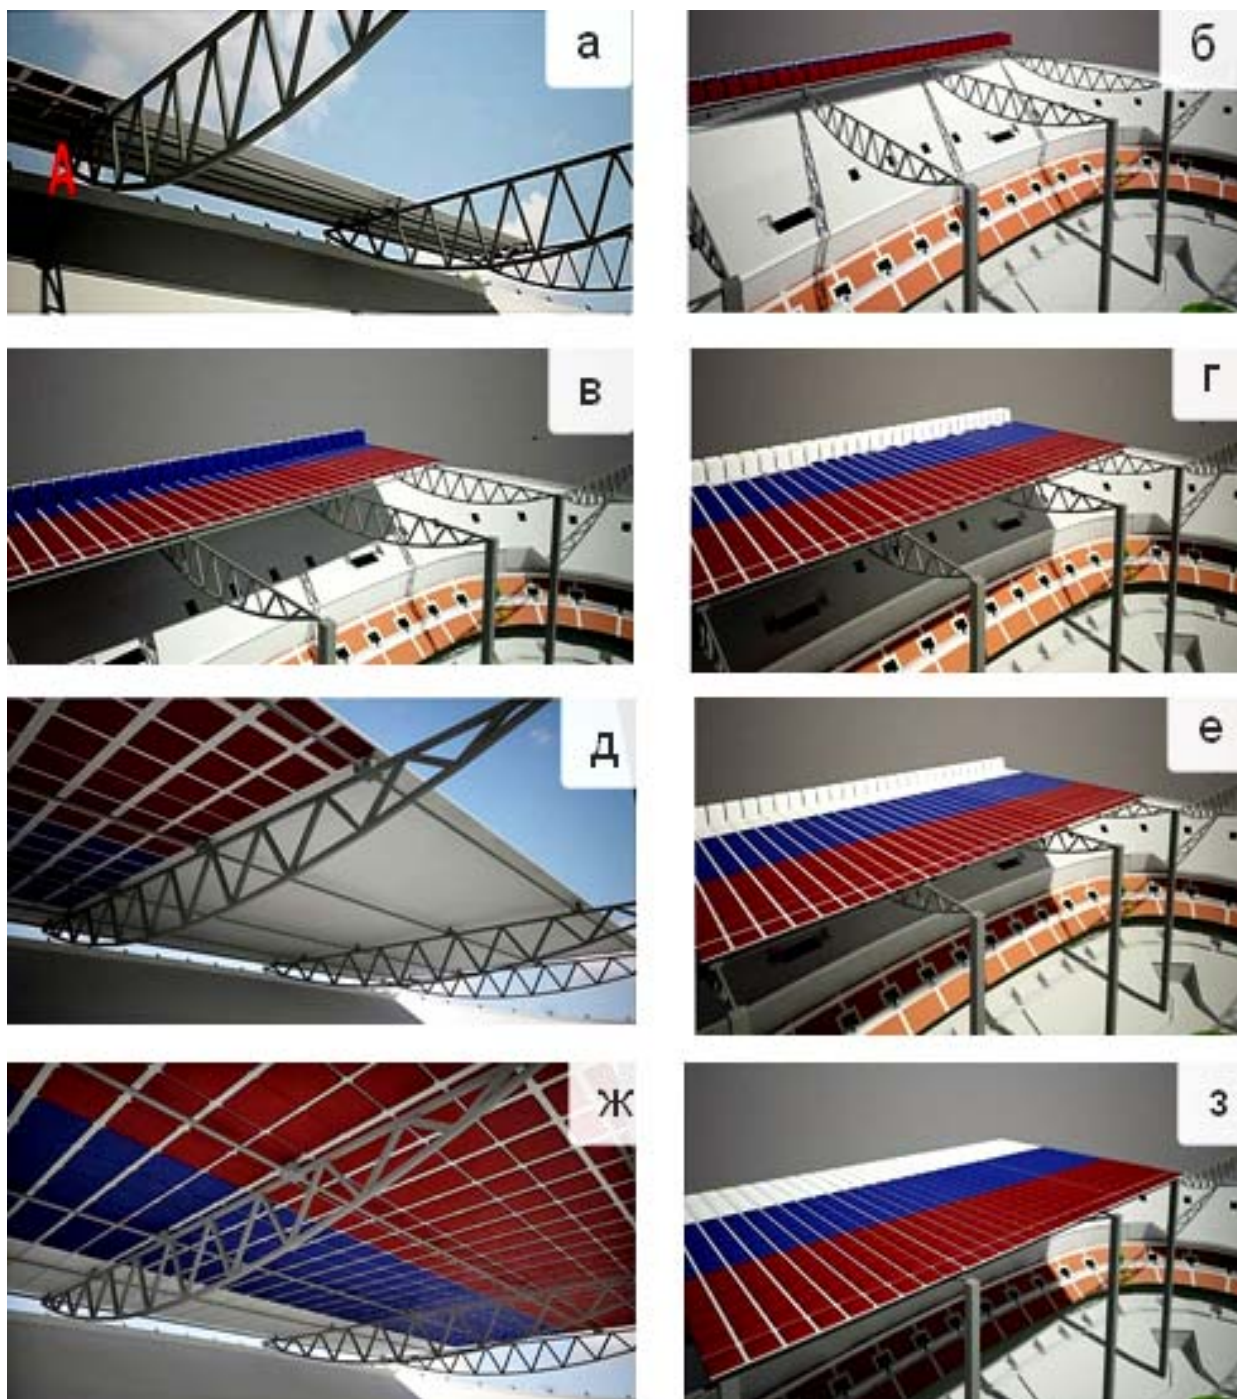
Положения кровельного покрытия из мембранных подушек:
